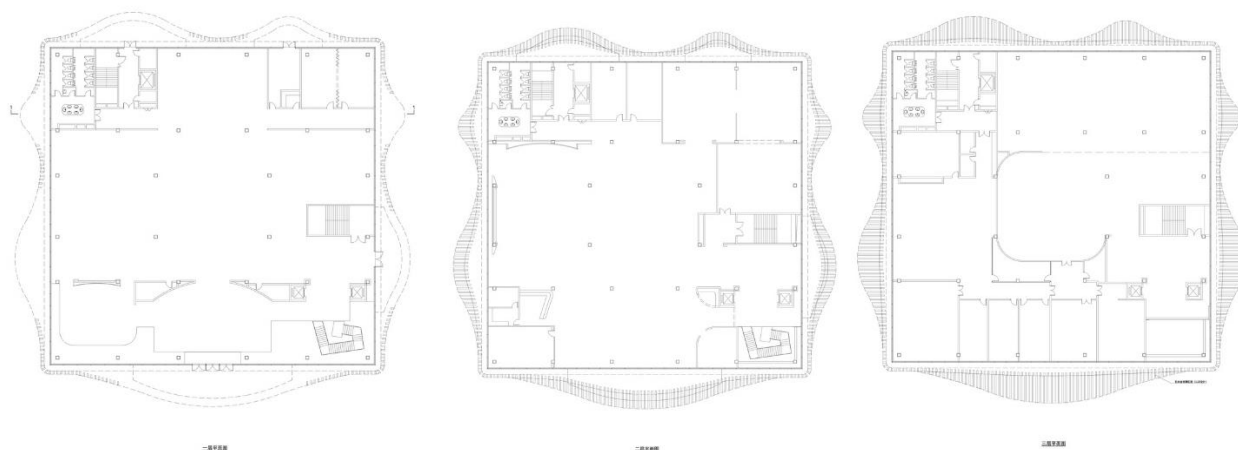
Плани 1-го,2-го,3-го поверхів [6]
